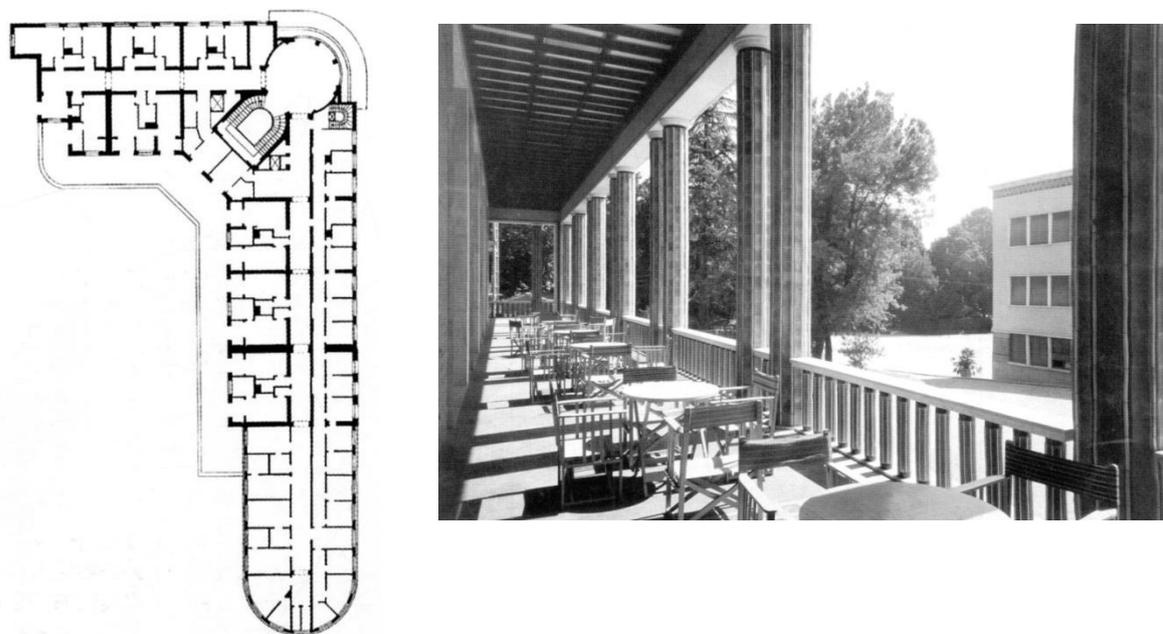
Grand Hotel. Pianta piano primo e vista dalla loggia
